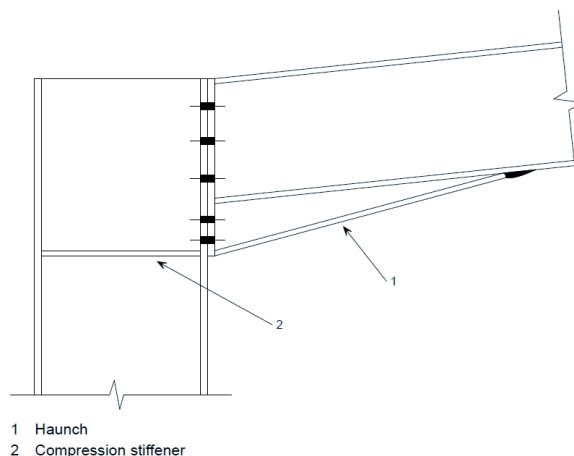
Ligação tipo pilar-viga (portal frame) (SECHALO, *Steel buildings in europe - single-storey steel buildings - Part2: Concept design*, 2012)
